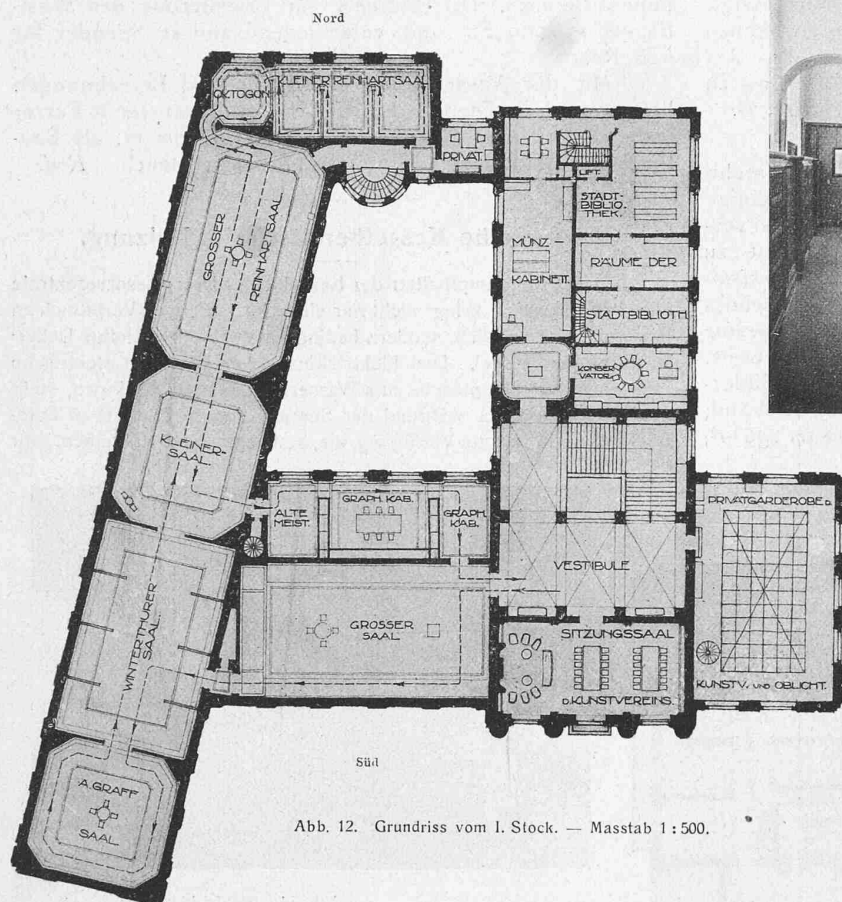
Grundriss vom I. Stock. — Masstab 1:500.
